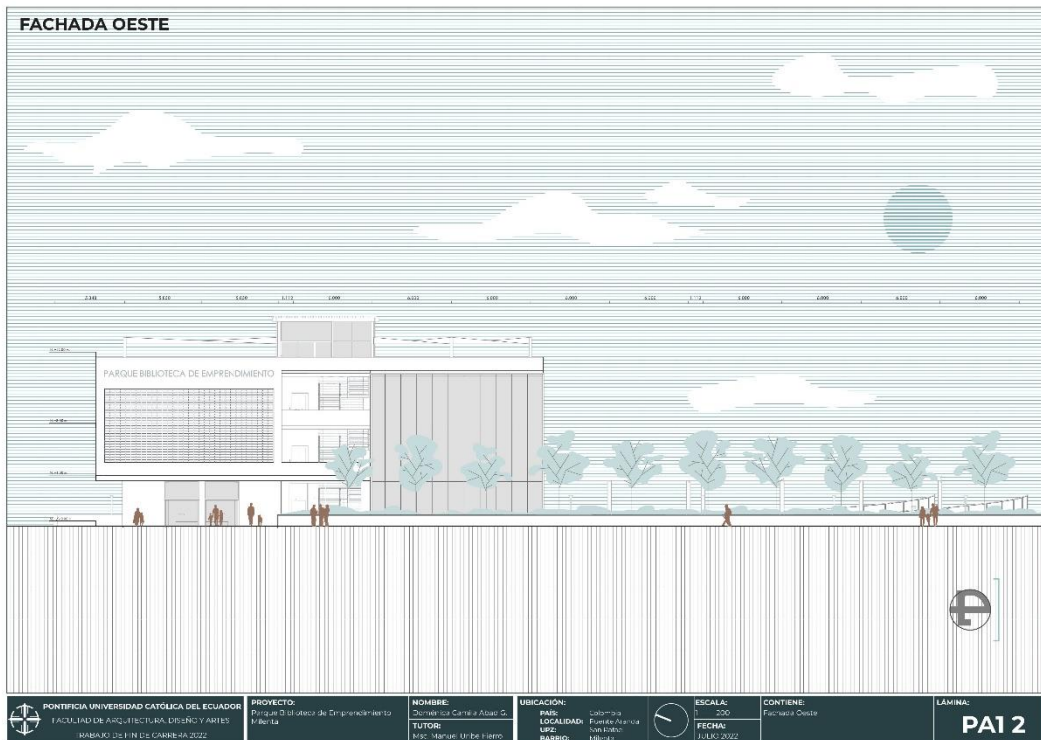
Fachada Oeste (Abad,D. 2022)
